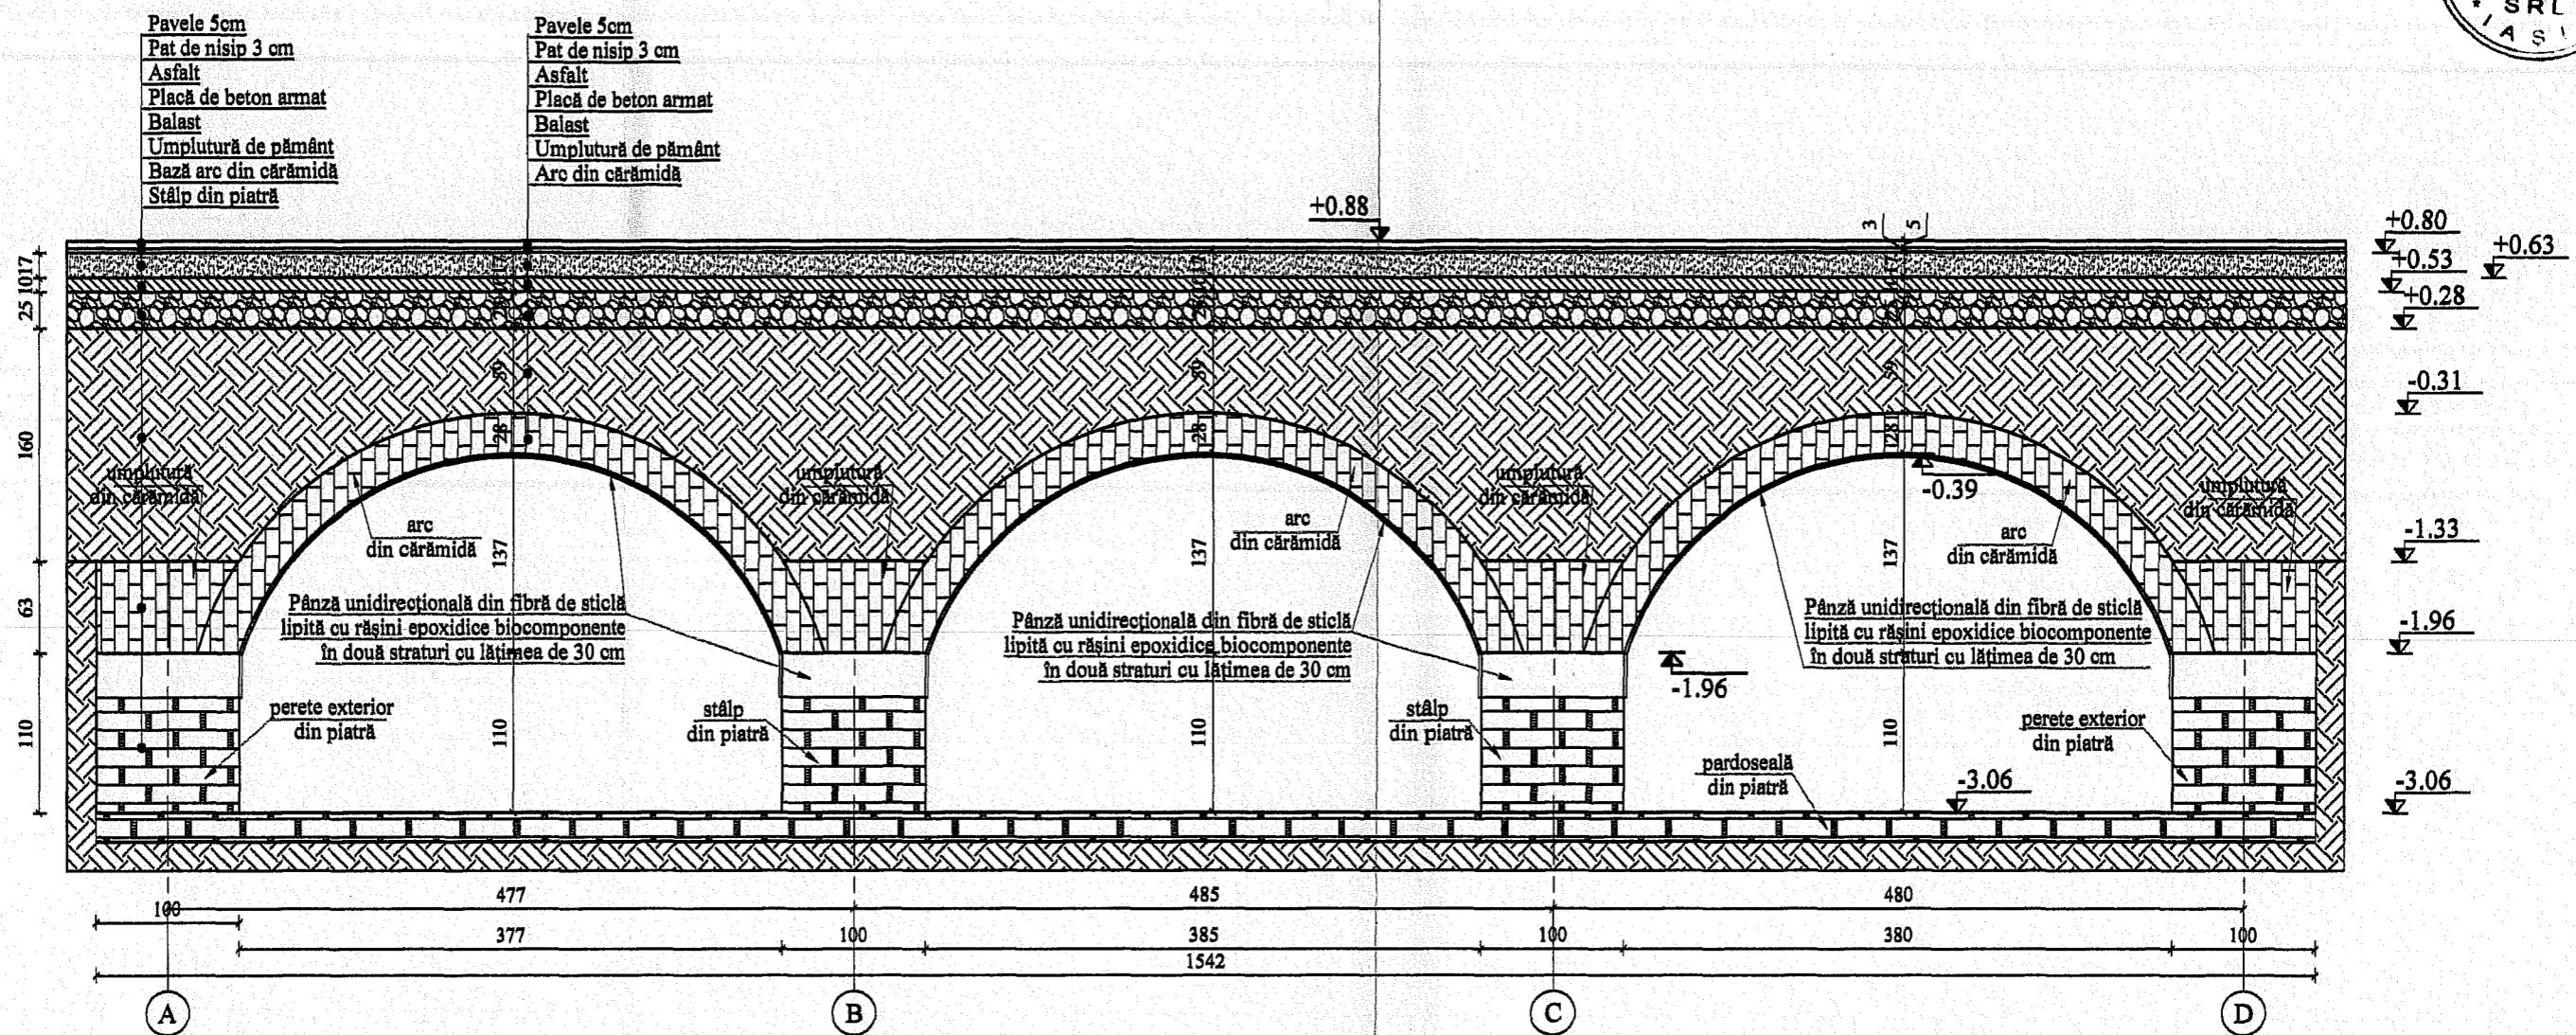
SECTIUNE LONGITUDINALĂ D-D - SITUAȚIE PROPUȘĂ
